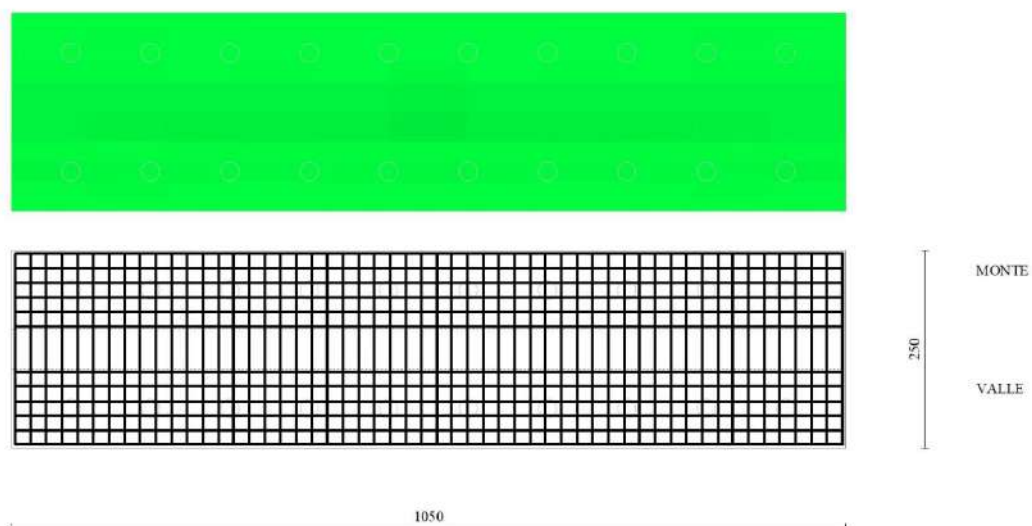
Piastra fondazione dir. Y (Inviluppo)
